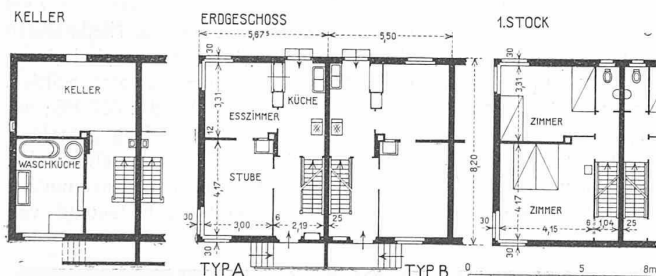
Grundrisse von Typ A und B. — Masstab 1 : 300.
